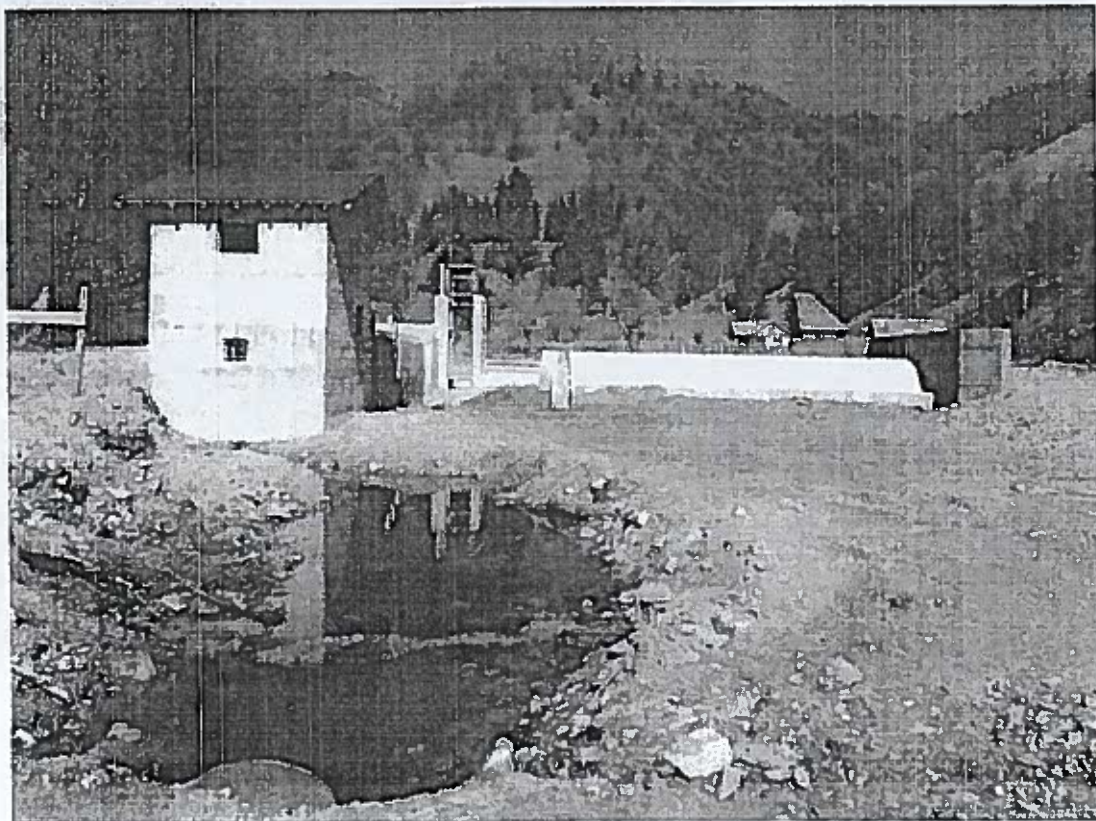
Limita ariei protejate în zona construcției MHC Taia
